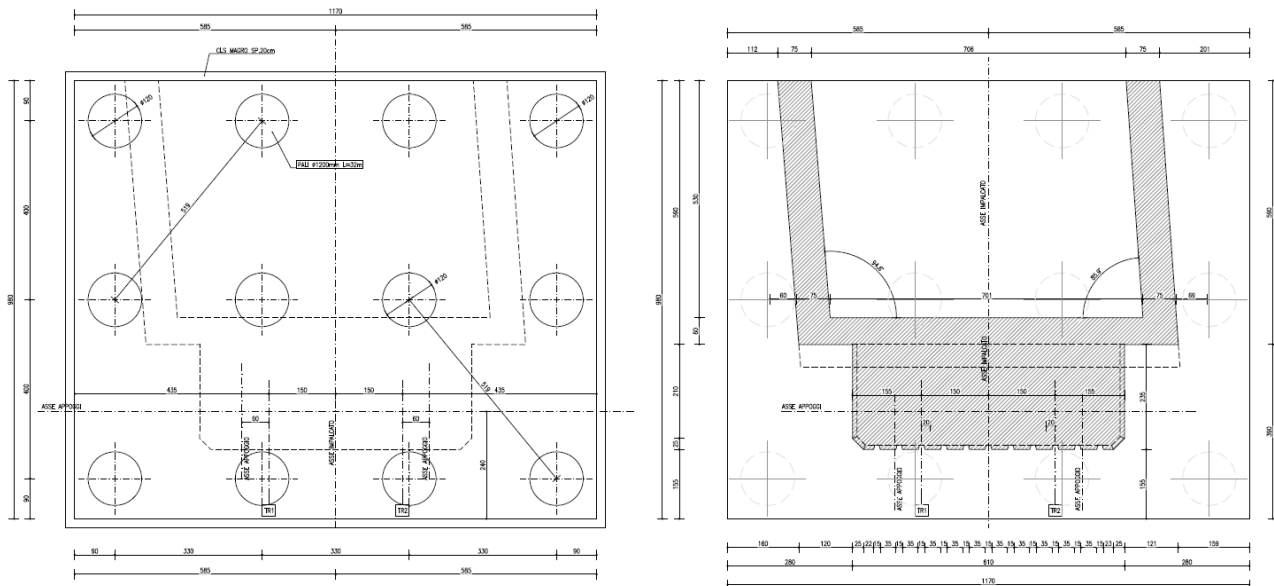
Spalla 1 – carpenteria fondazioni
